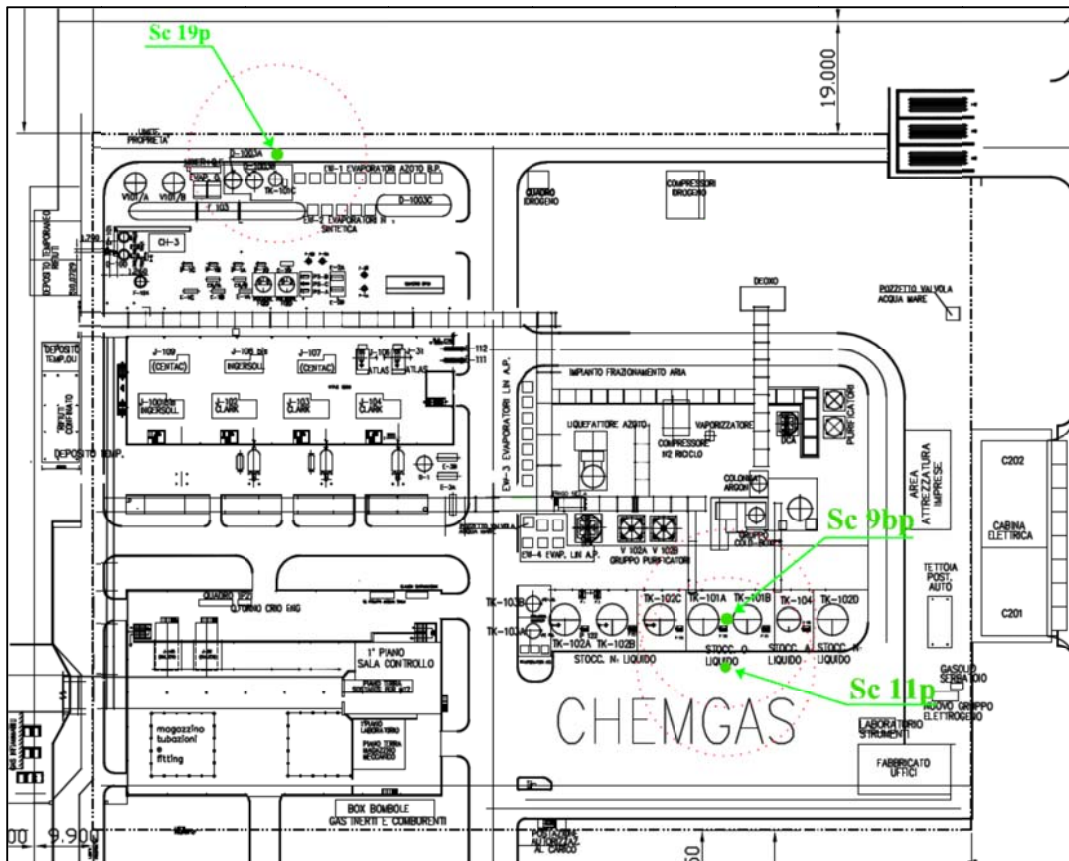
Stralcio della Planimetria limiti proprietà impianto - Dispersioni Ossigeno Rottura Parziale D5
